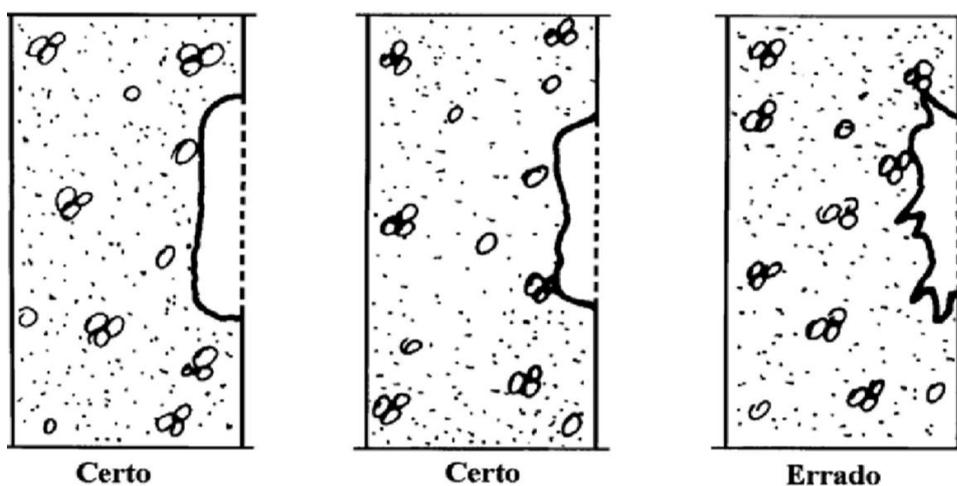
Aspecto final da cavidade na intervenção de corte de concreto (Souza e Ripper, 1998)
